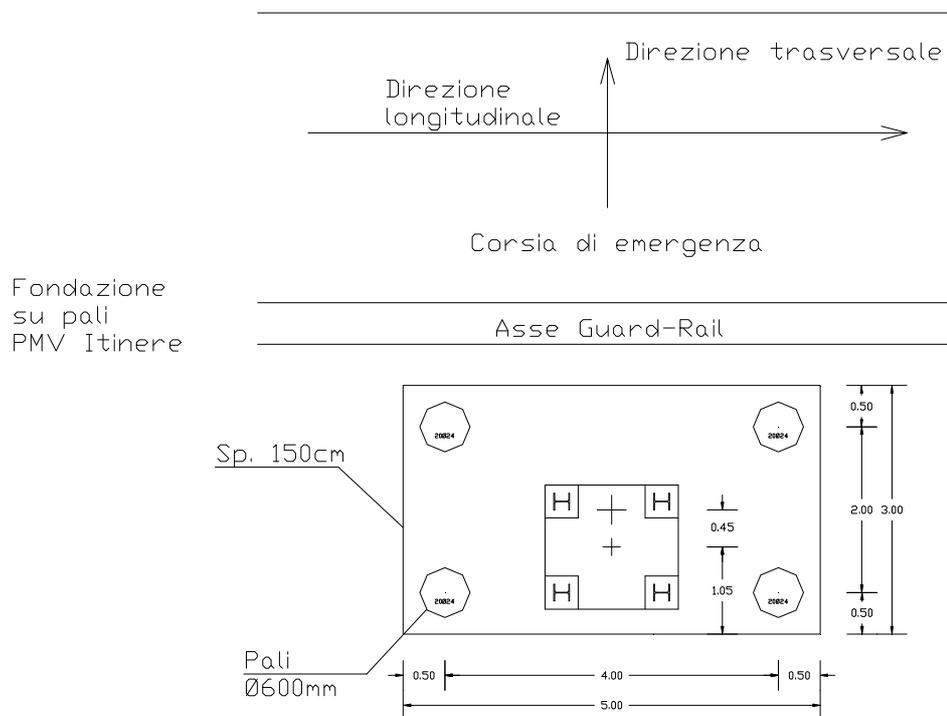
pianta degli elementi di fondazione dei pannelli a messaggistica variabile
